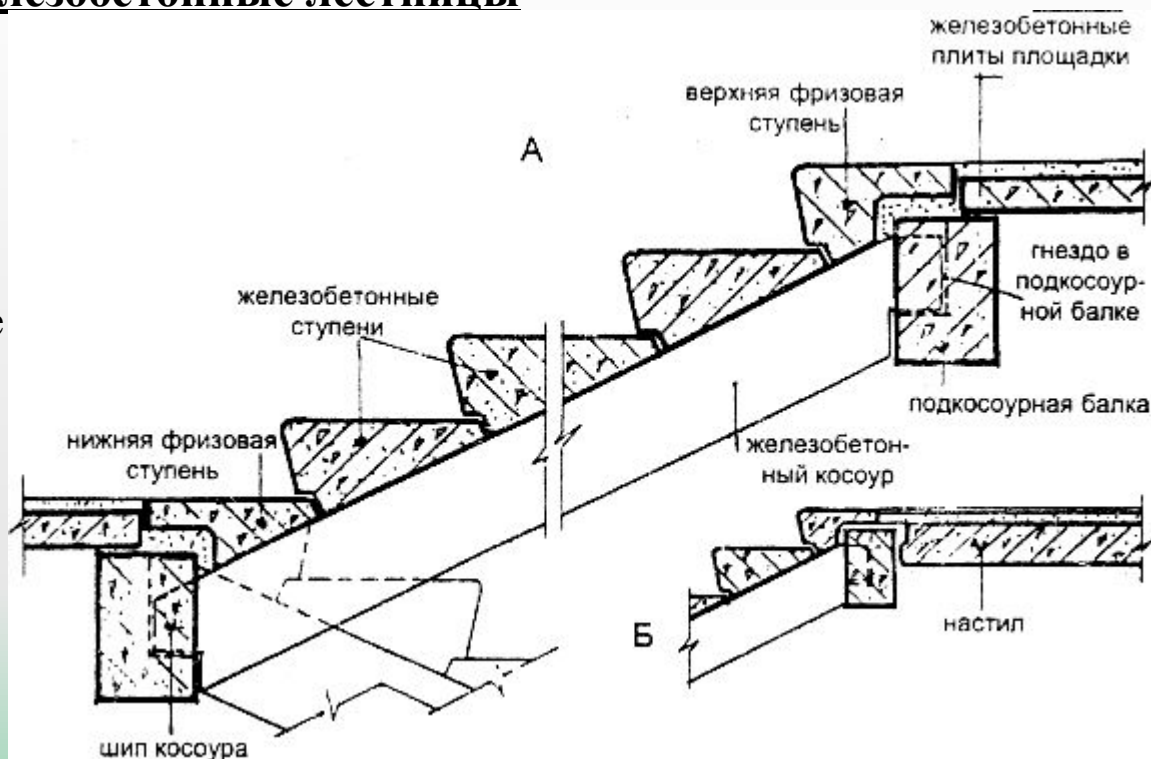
Мелкоэлементная лестница по железобетонным косоурам
